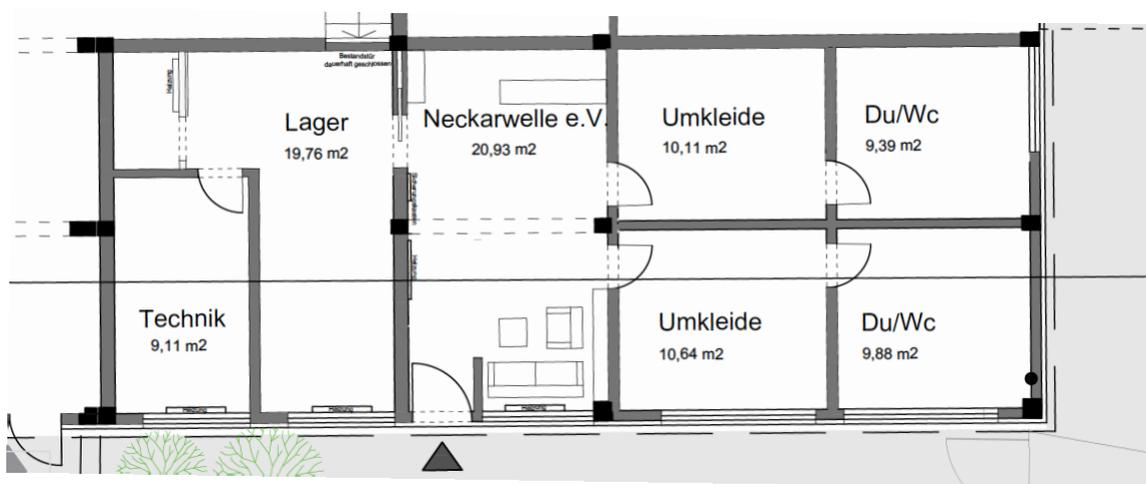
Grundriss Sanierung ehemalige Hausmeisterstube. Quelle: MBA/S
